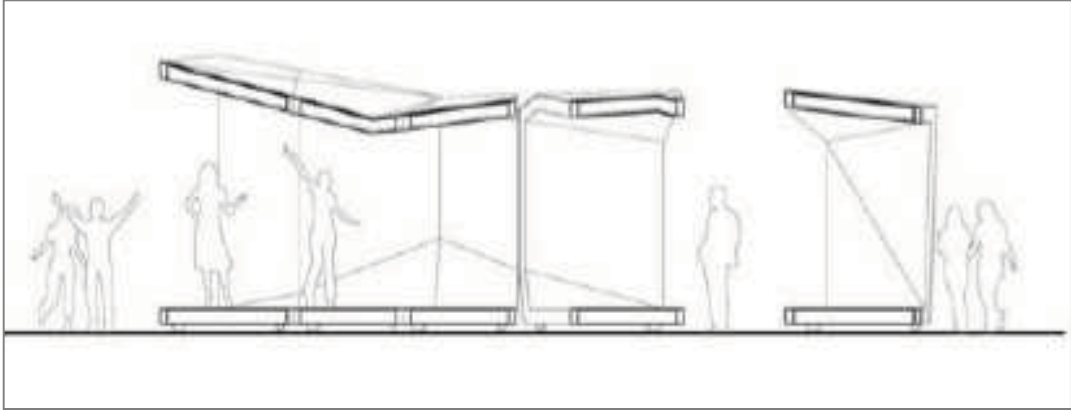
Proyecto City Intervention /ba\_lik pavilion
